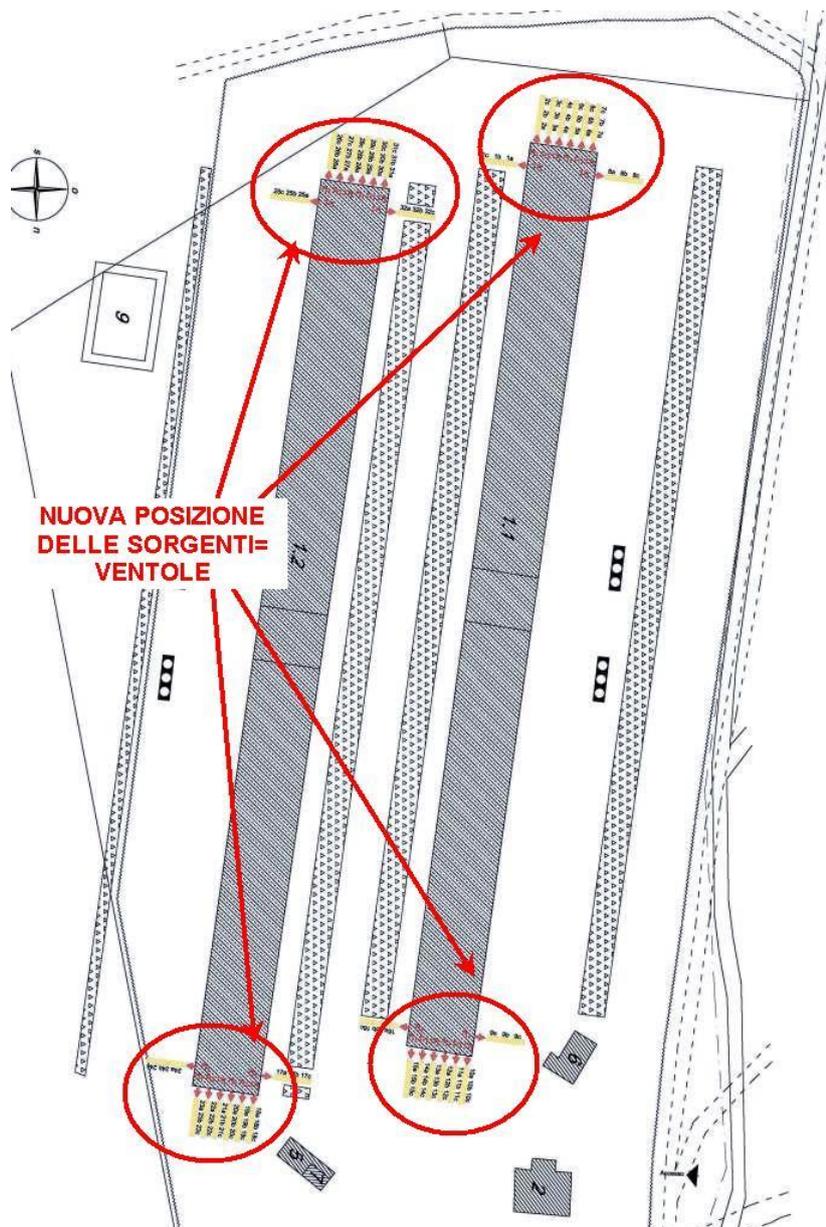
Planimetria Ventilazione post modifica - MORRO D'ORO.
